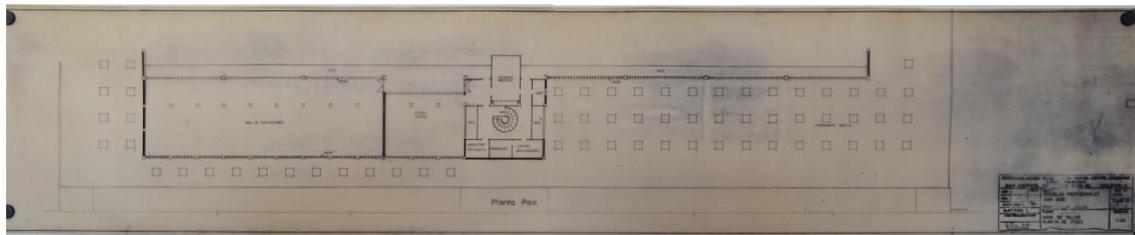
Plano planta primera taller. *Archivo Escuelas San José.
